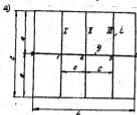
Рис. II. Схема рассматриваемого перекрытия и условия на балках:
